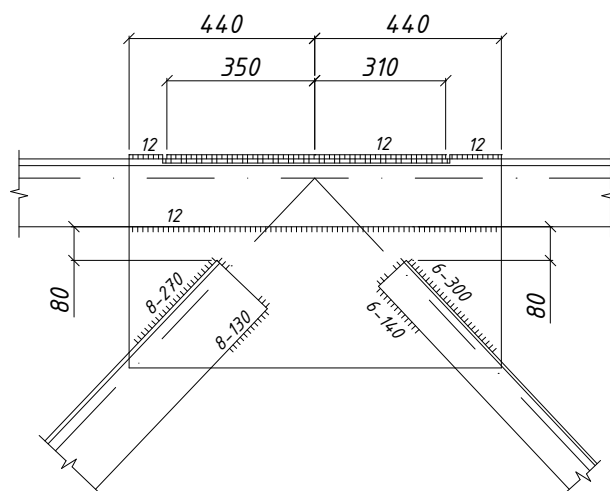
Вузол фасонного з'єднання верхнього пояса та опорного розкосу
